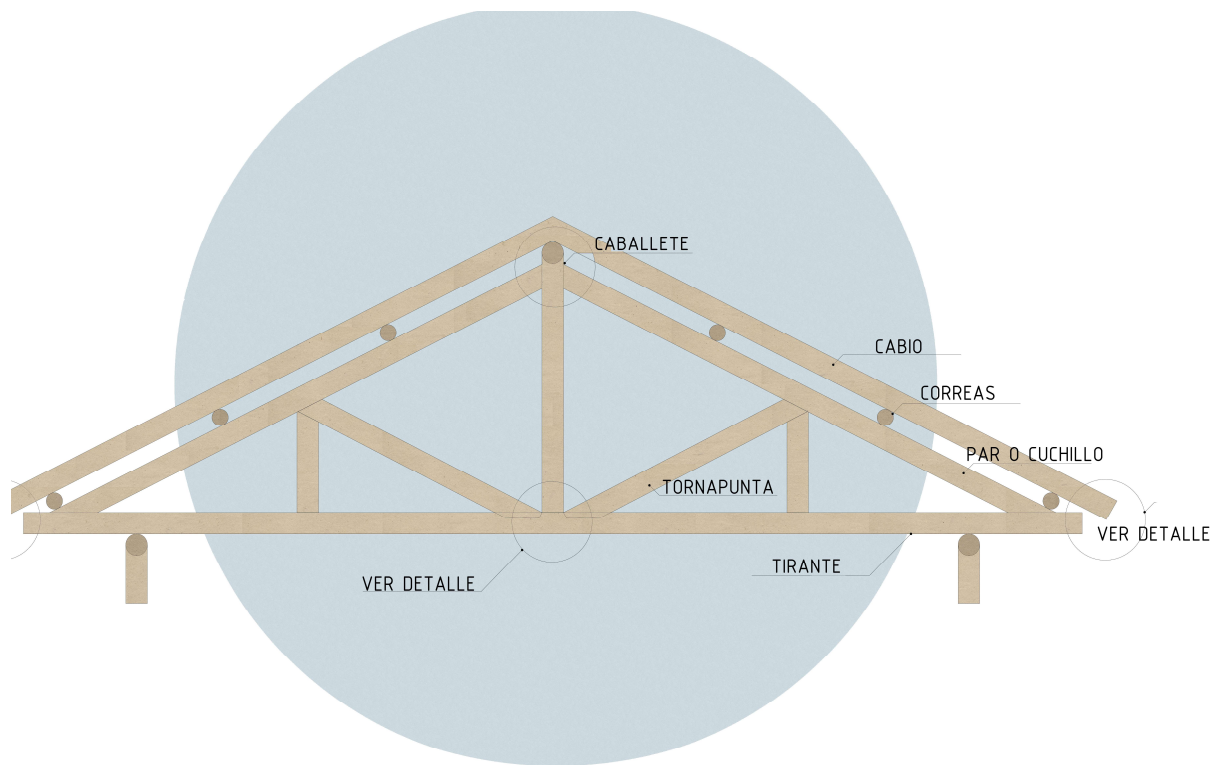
Ejemplo de armaduras que se pueden fabricar con bambú.
